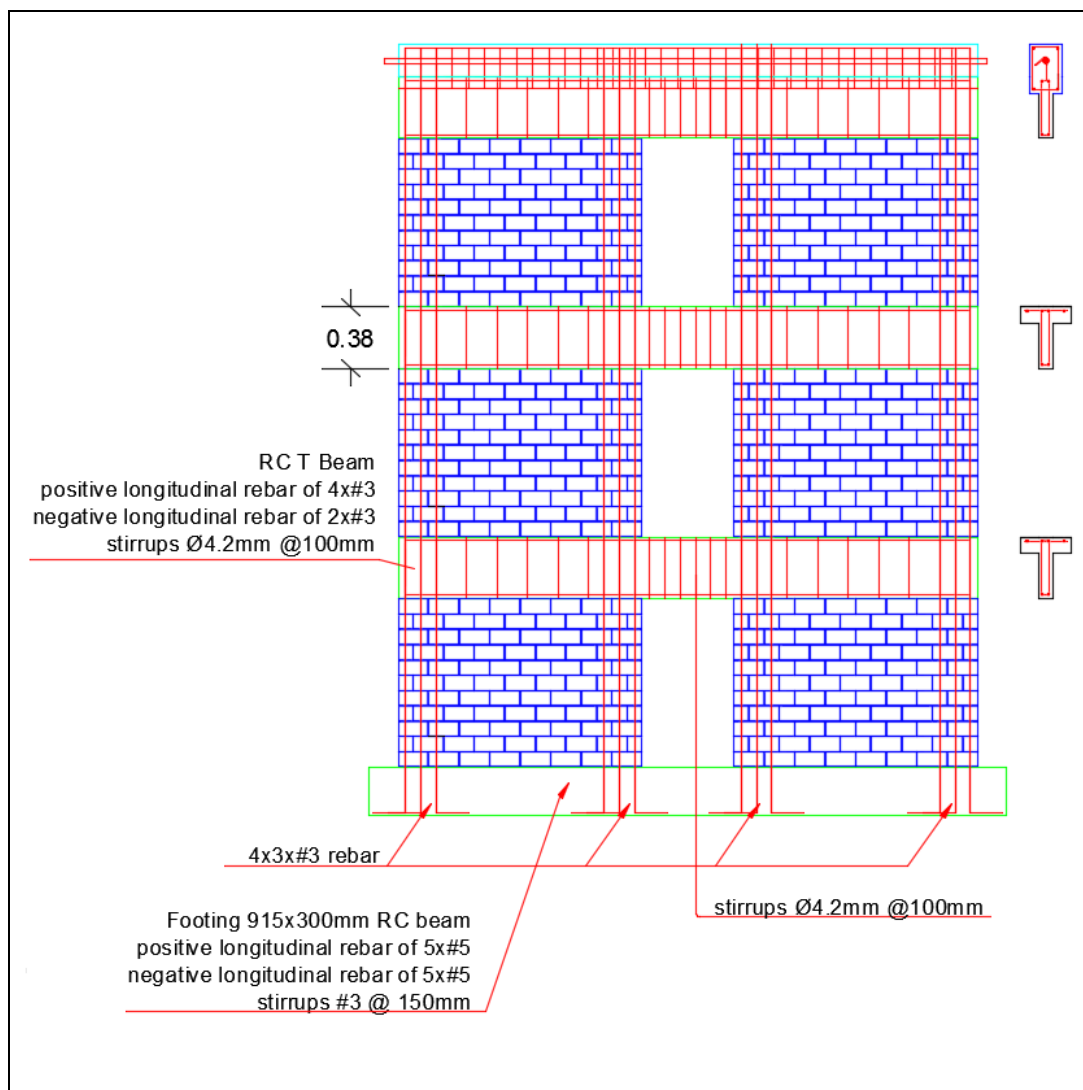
Geometria das paredes acopladas com viga de concreto armado e detalhe das armaduras,
